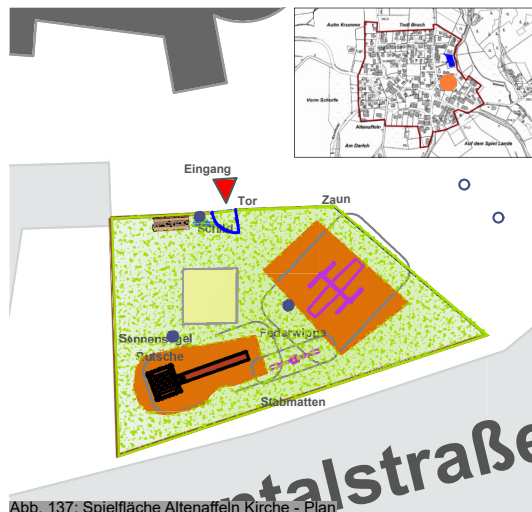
Spielfläche Altenaffeln Kirche - Plan
